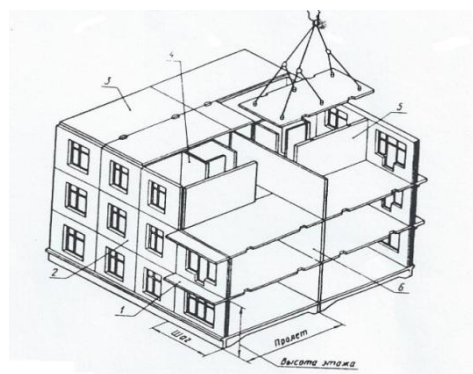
Конструктивные элементы крупнопанельного здания: 1-плита балкона, 2-наружная стенная панель, 3-панель перекрытия, 4-вентиляционная панель, 5- перегородочная панель, 6-внутренняя стенная панель
